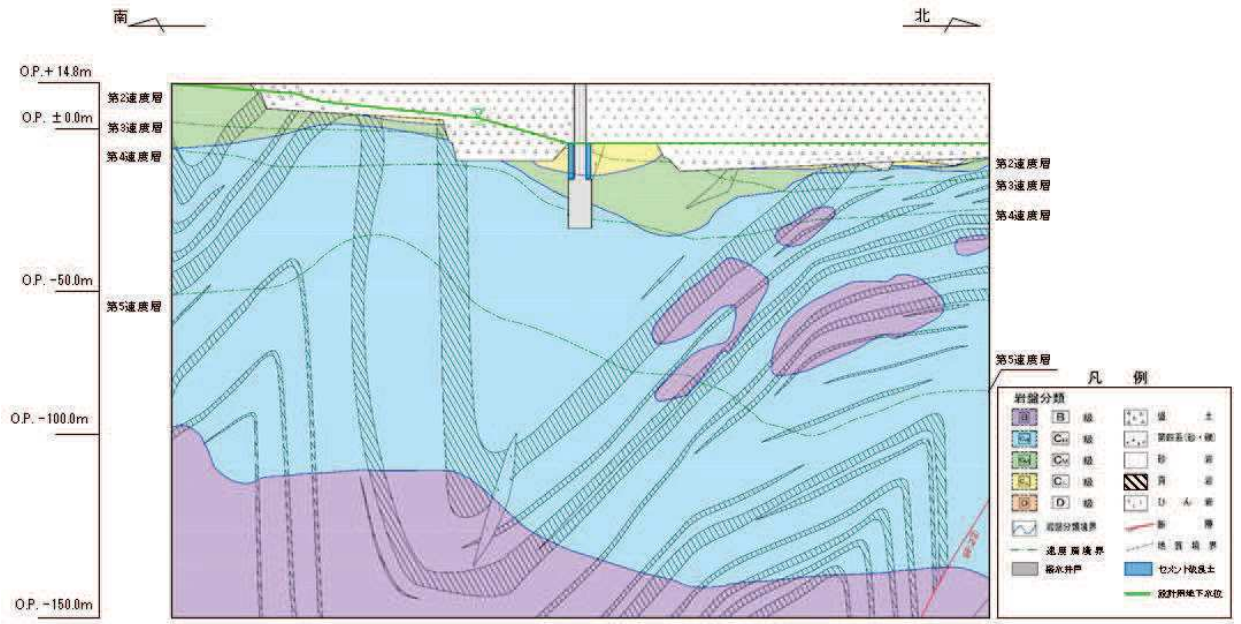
(1) No.1 揚水井戸 評価対象断面図 (A'-A断面)
